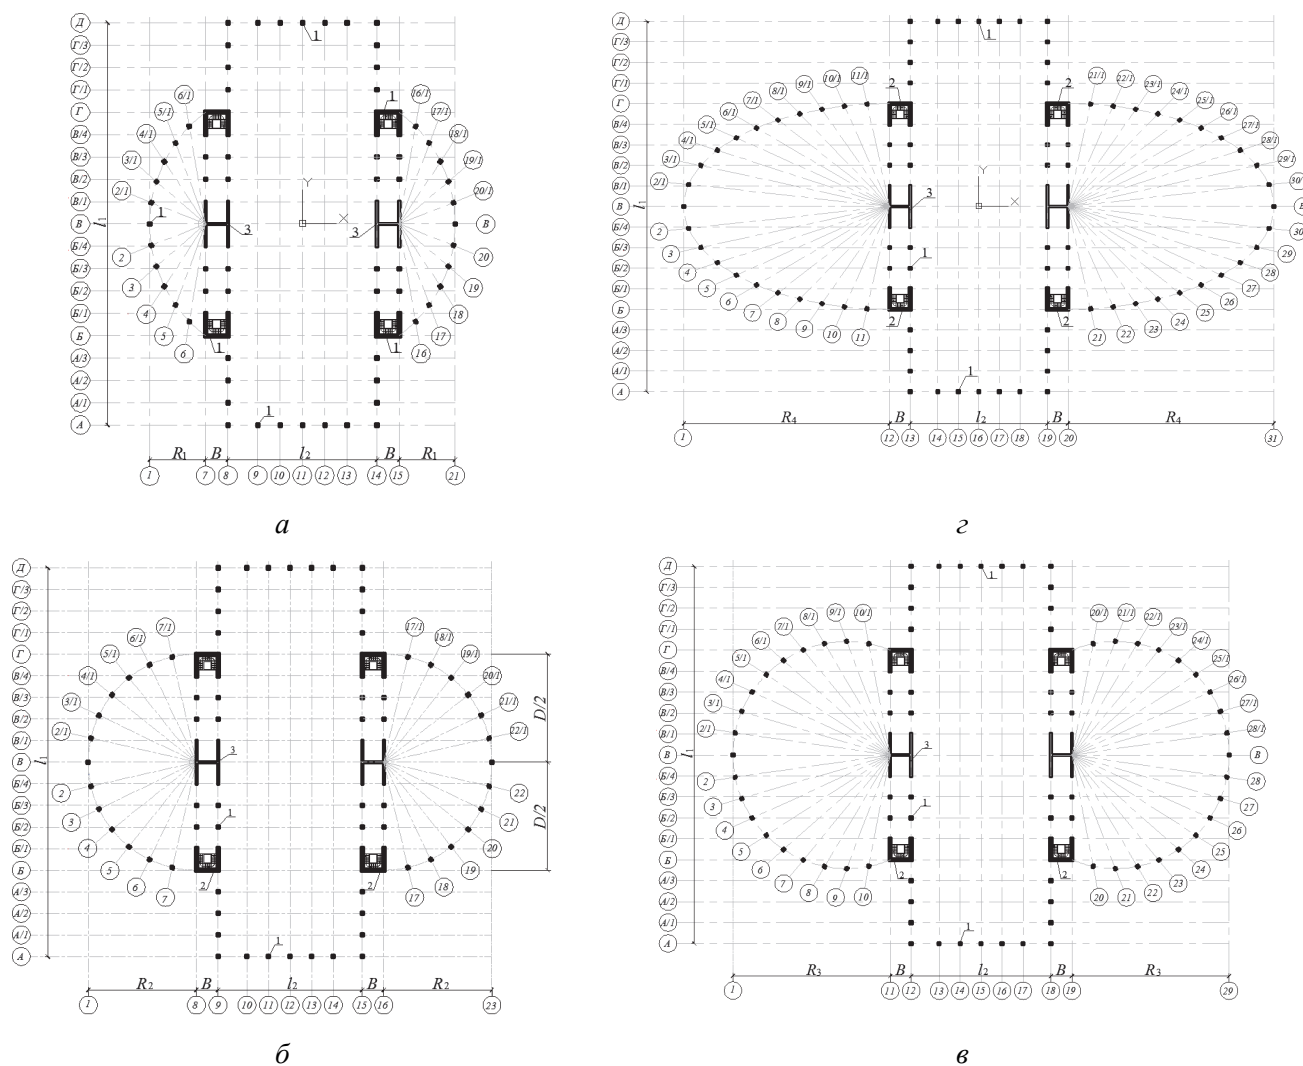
Планы зданий ЦПВ-покрытий с наружными опорными контурами:
